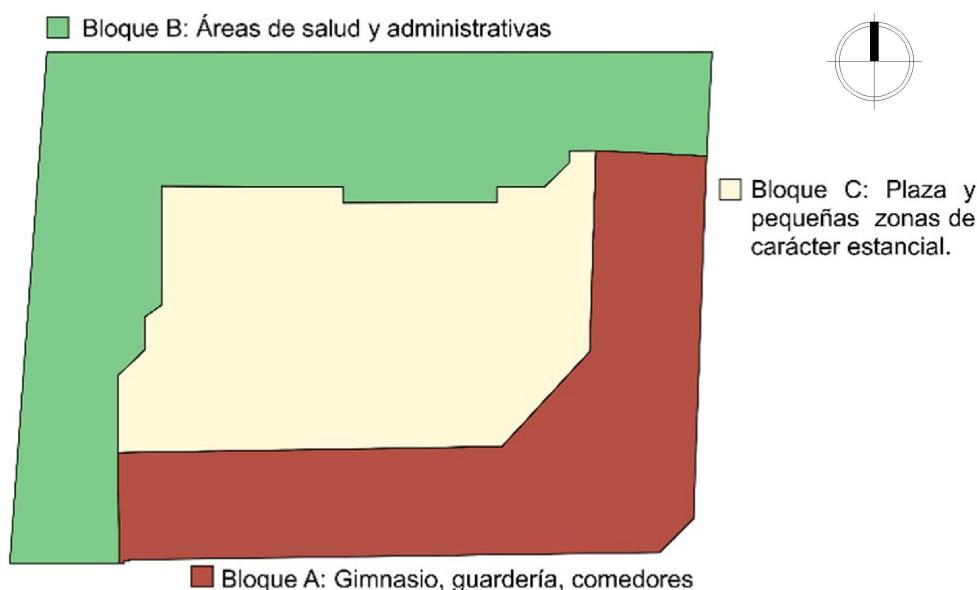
Distribución en planta de las áreas establecidas en el proyecto. Fuente y elaboración: Autores
